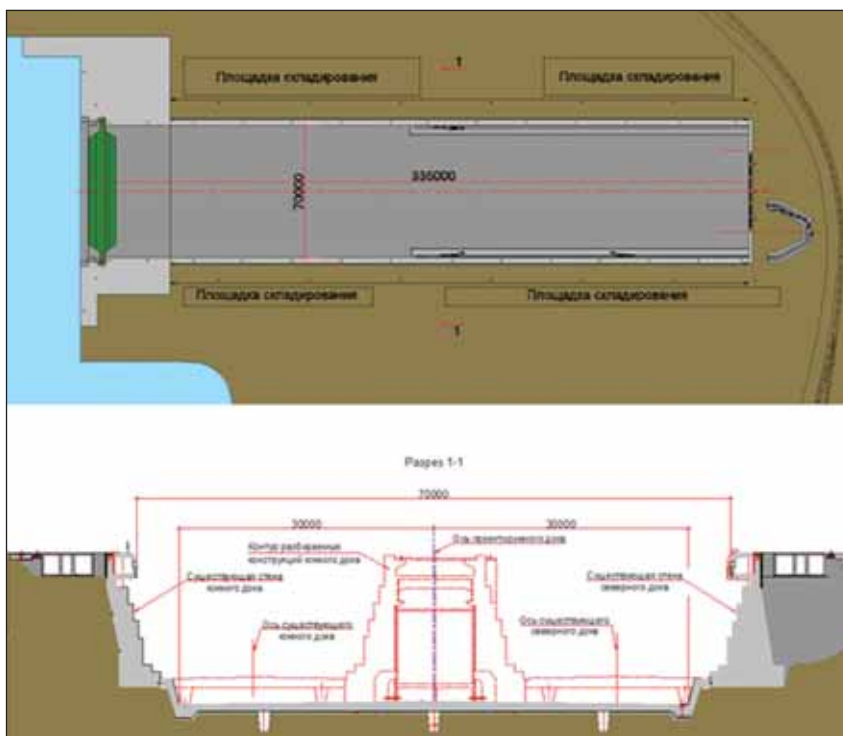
Реконструкция доков по варианту 2. План и поперечный разрез
